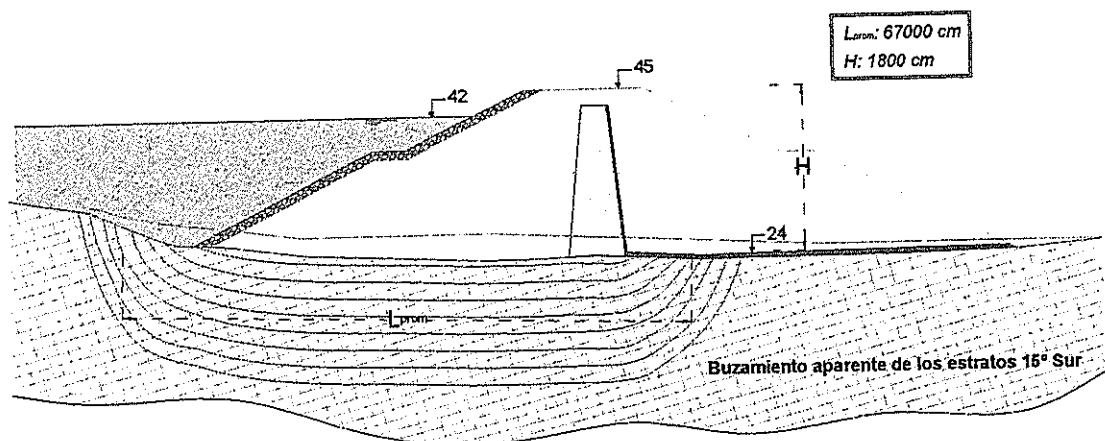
Infiltraciones en el sistema de fracturas del terreno de fundación.
